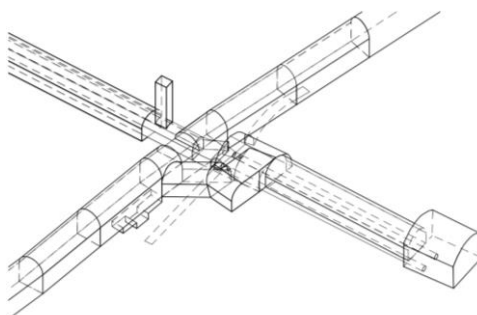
Vista 3D della galleria trasversale dello scarico di fondo, della galleria longitudinale di drenaggio e ispezione e delle camere di manovra
